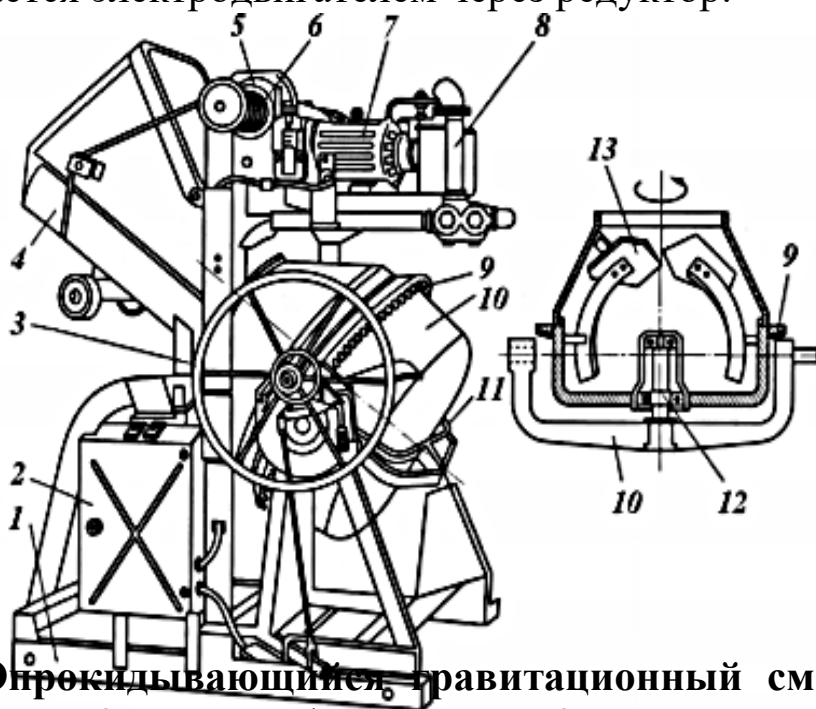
Опрокидывающийся гравитационный смесительный барабан: 1-рама; 2-электрооборудование; 3-штурвал опрокидывания барабана; 4- скиповый ковш; 5- червячный редуктор; 6-подъемник
